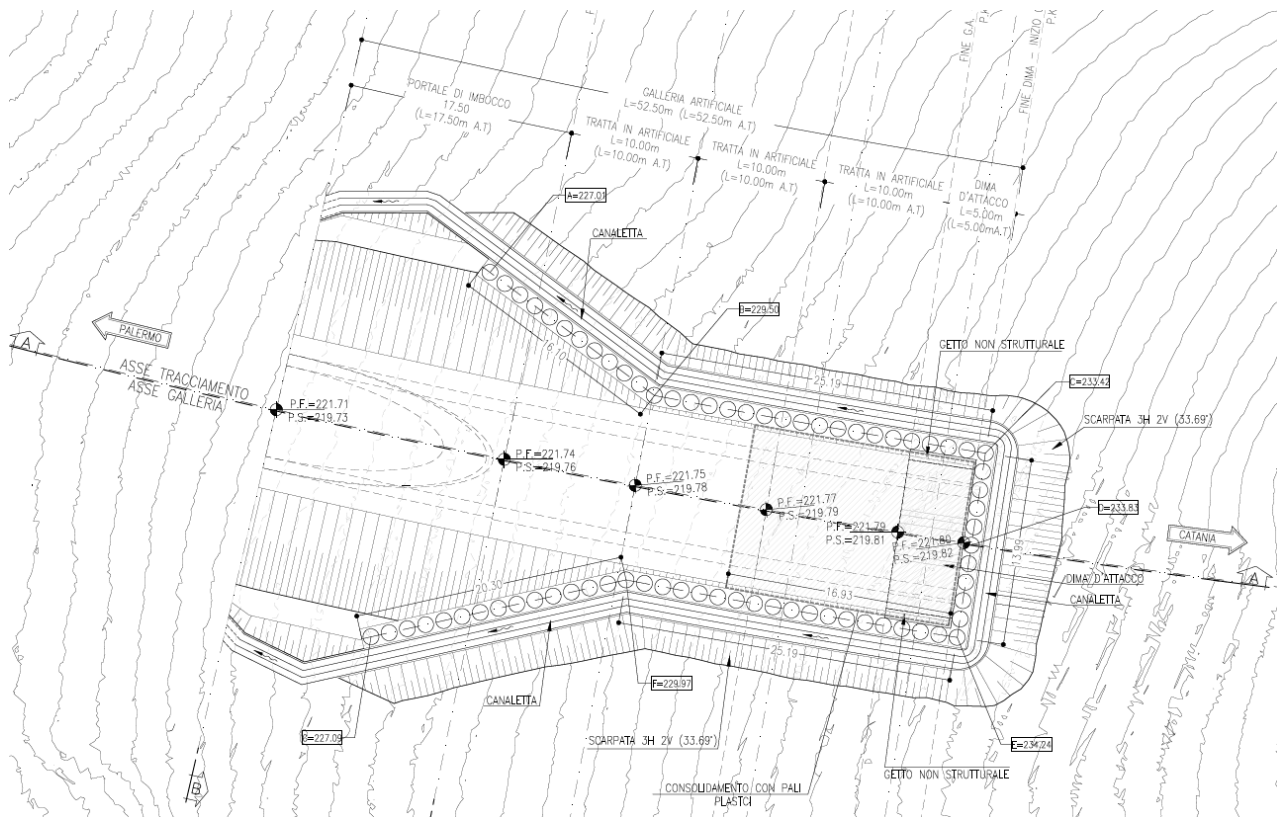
Planimetria imbocco lato Palermo – fase provvisoria
